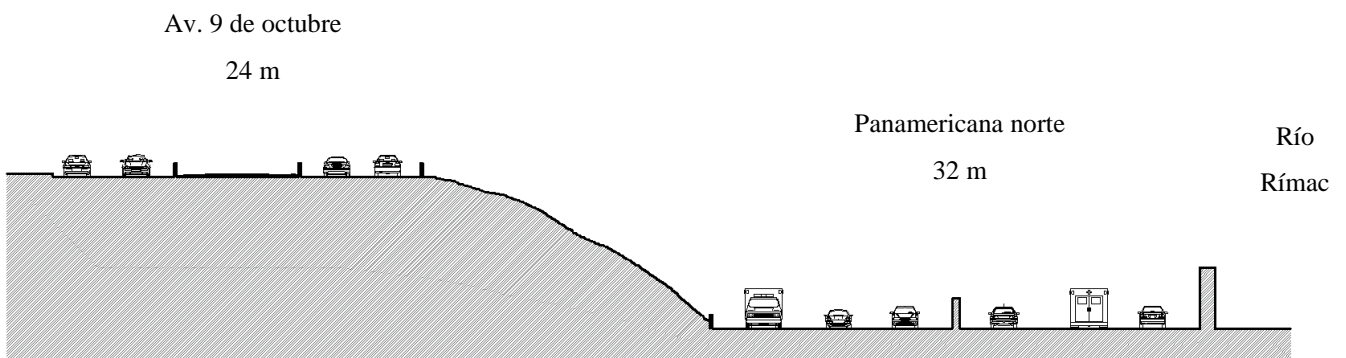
Sección de la Panamericana norte. Fuente : Elaboración propia
